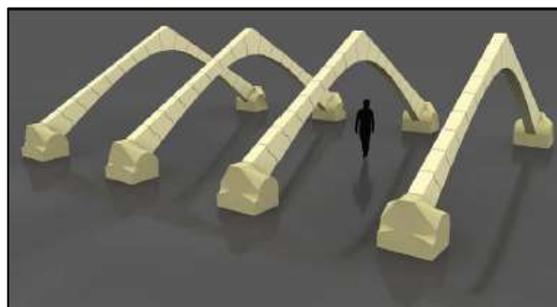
des arc construit en pierre/(sources:alliche:2018)
